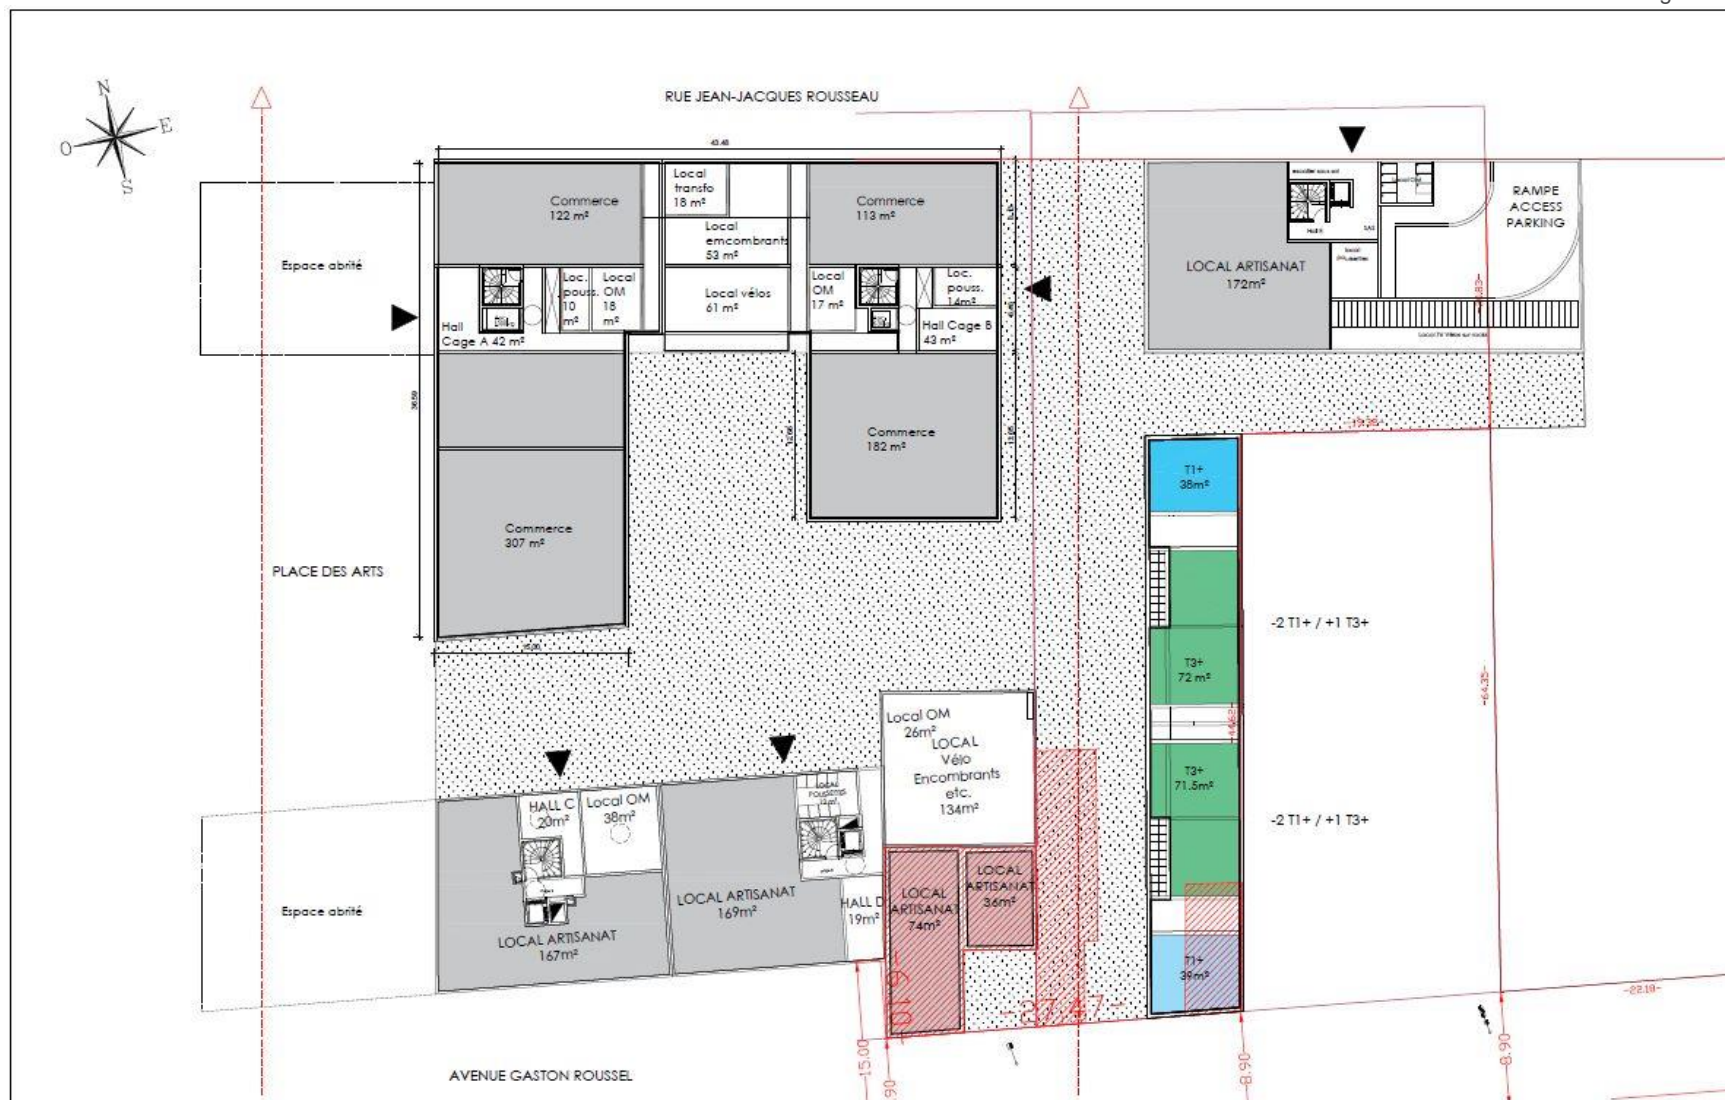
Plan du rez-de-chaussée (source : Wilmotte et Associés SA, 09/09/2019)
